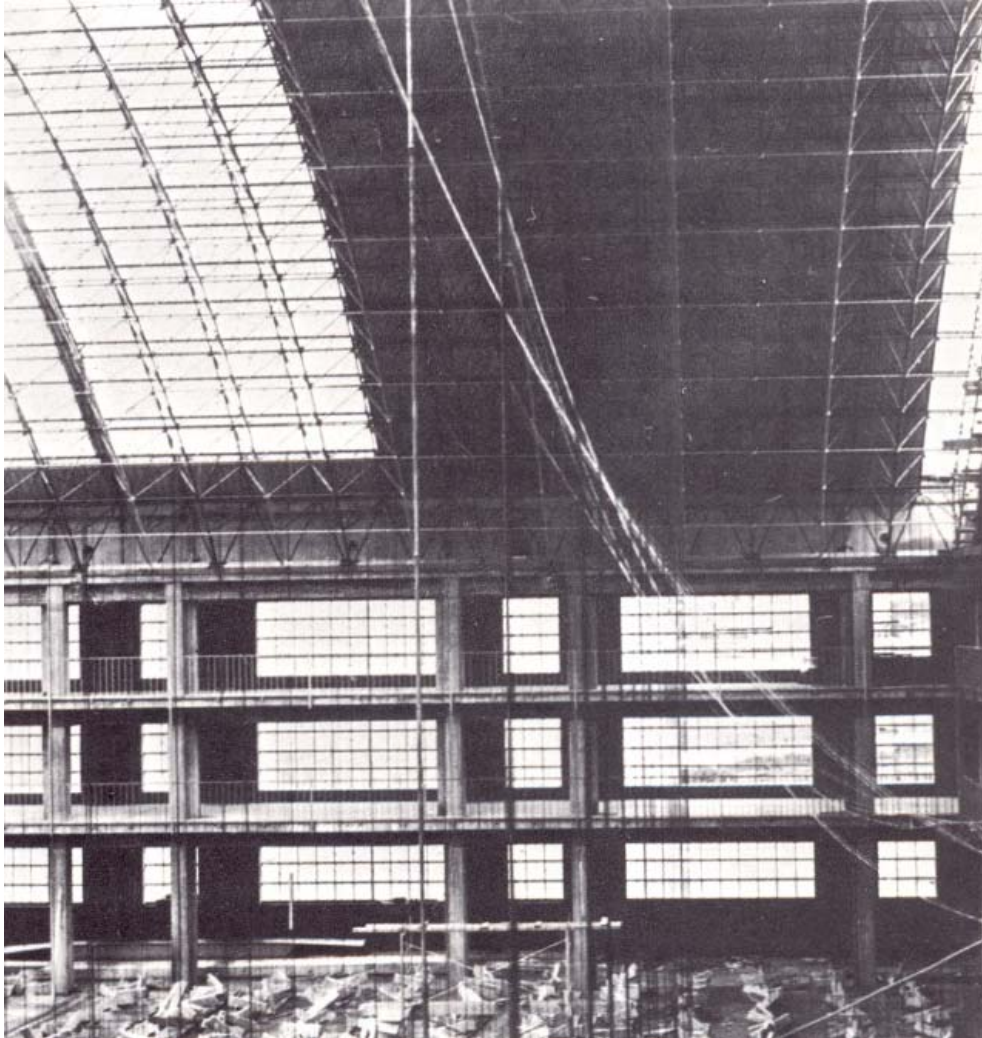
Detalle de la forma de materialización de la carga, durante la prueba de carga, a base de elementos de hormigón colgados de cables fijados a las esferas inferiores.
